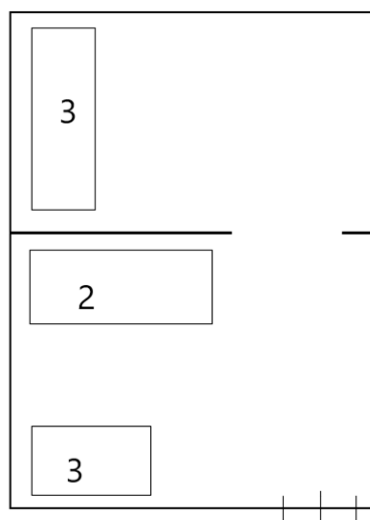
План размещения пожарной нагрузки в слесарной
